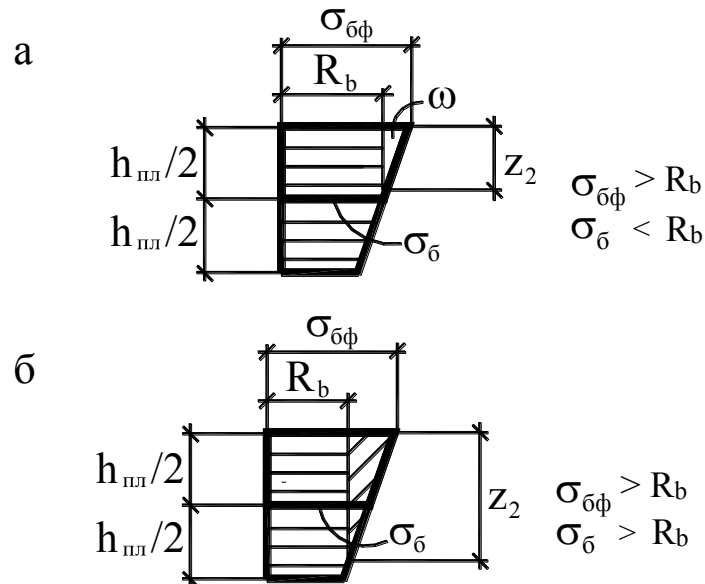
Схема к определению напряжений в железобетонной плите при работе железобетона в пластической стадии
